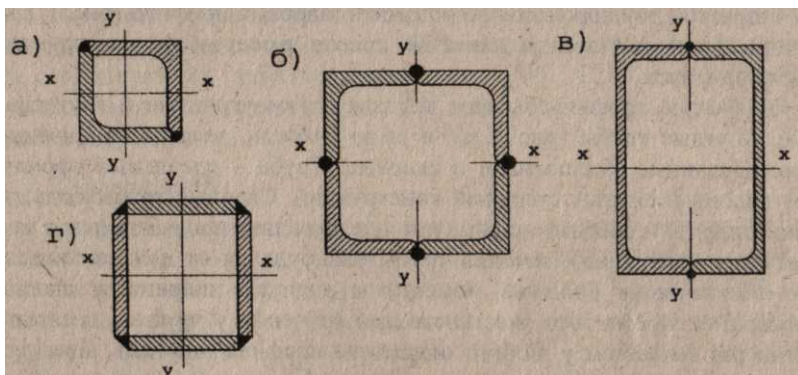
Прямоугольные сварные трубы:
